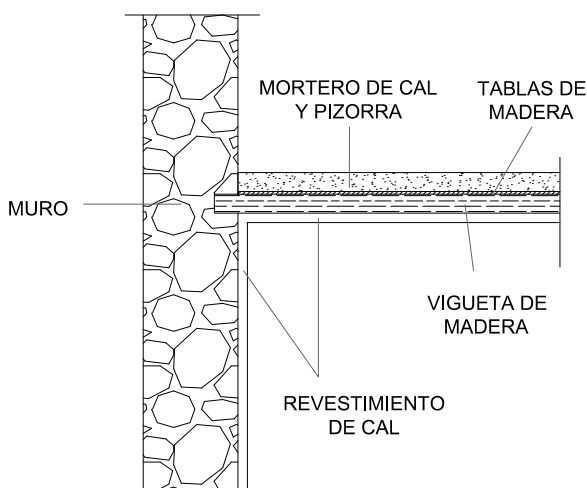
Apoyo de forjado sobre carrera. Fuente propia.
